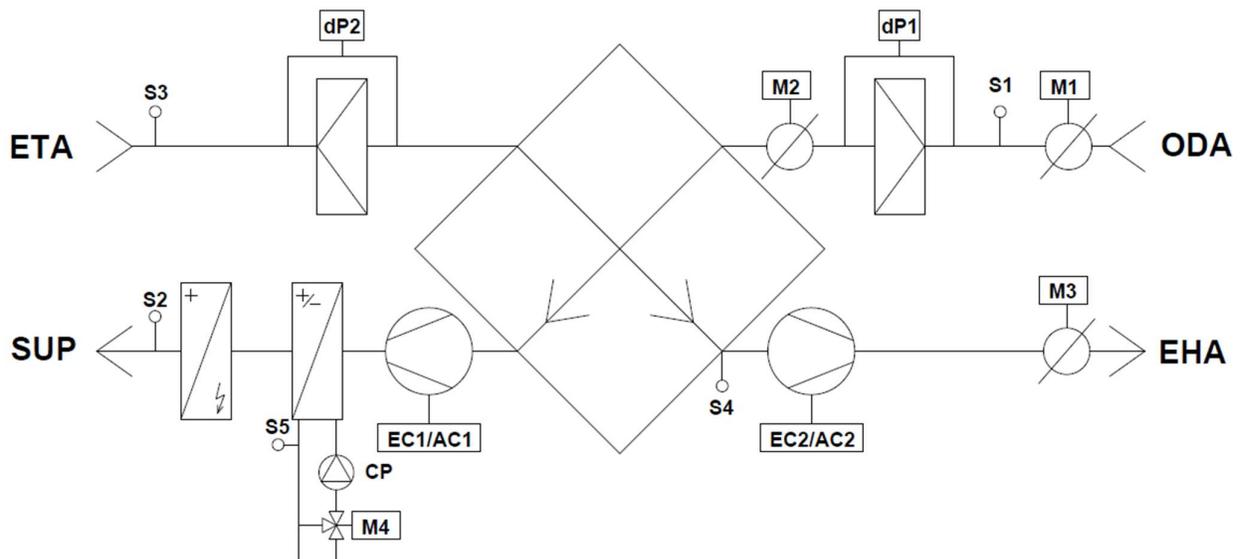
MSR-System, Konfiguration mit dem elektrischen Erhitzer und dem Wassererhitzer/Wasserkühler, linksseitige Ausführung
